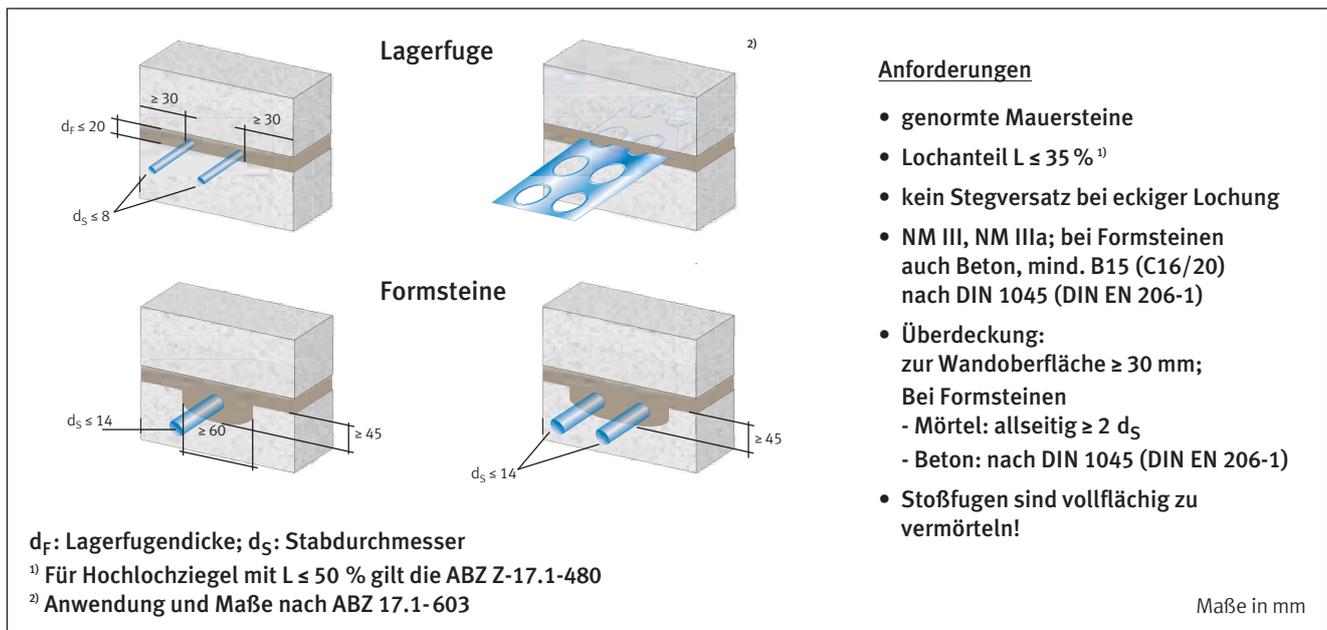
Bewehrtes Mauerwerk nach DIN 1053-3, horizontale Bewehrung – Bewehrungsführung und wichtige Maße
